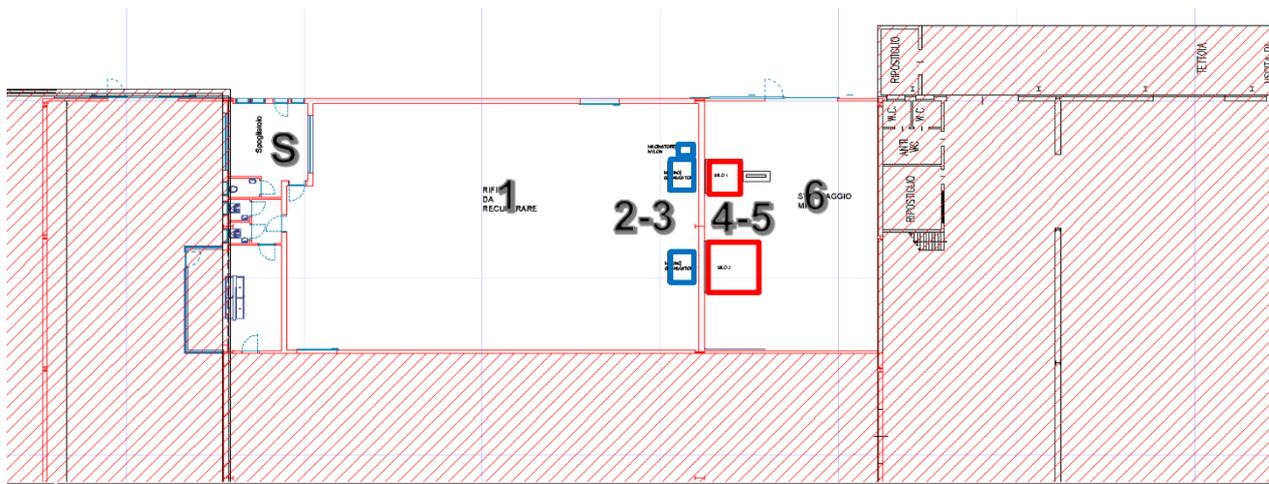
Planimetria con localizzazione degli impianti nello stabilimento
